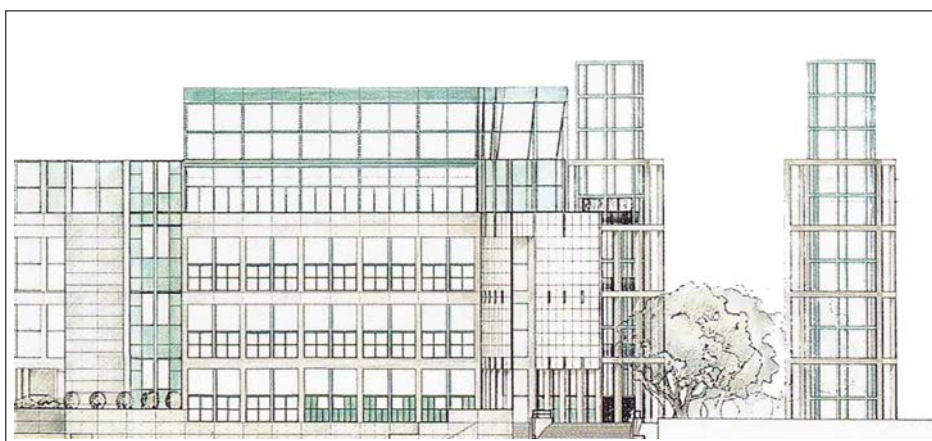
Alzado del anteproyecto “Ola”, de Gae Aulenti
